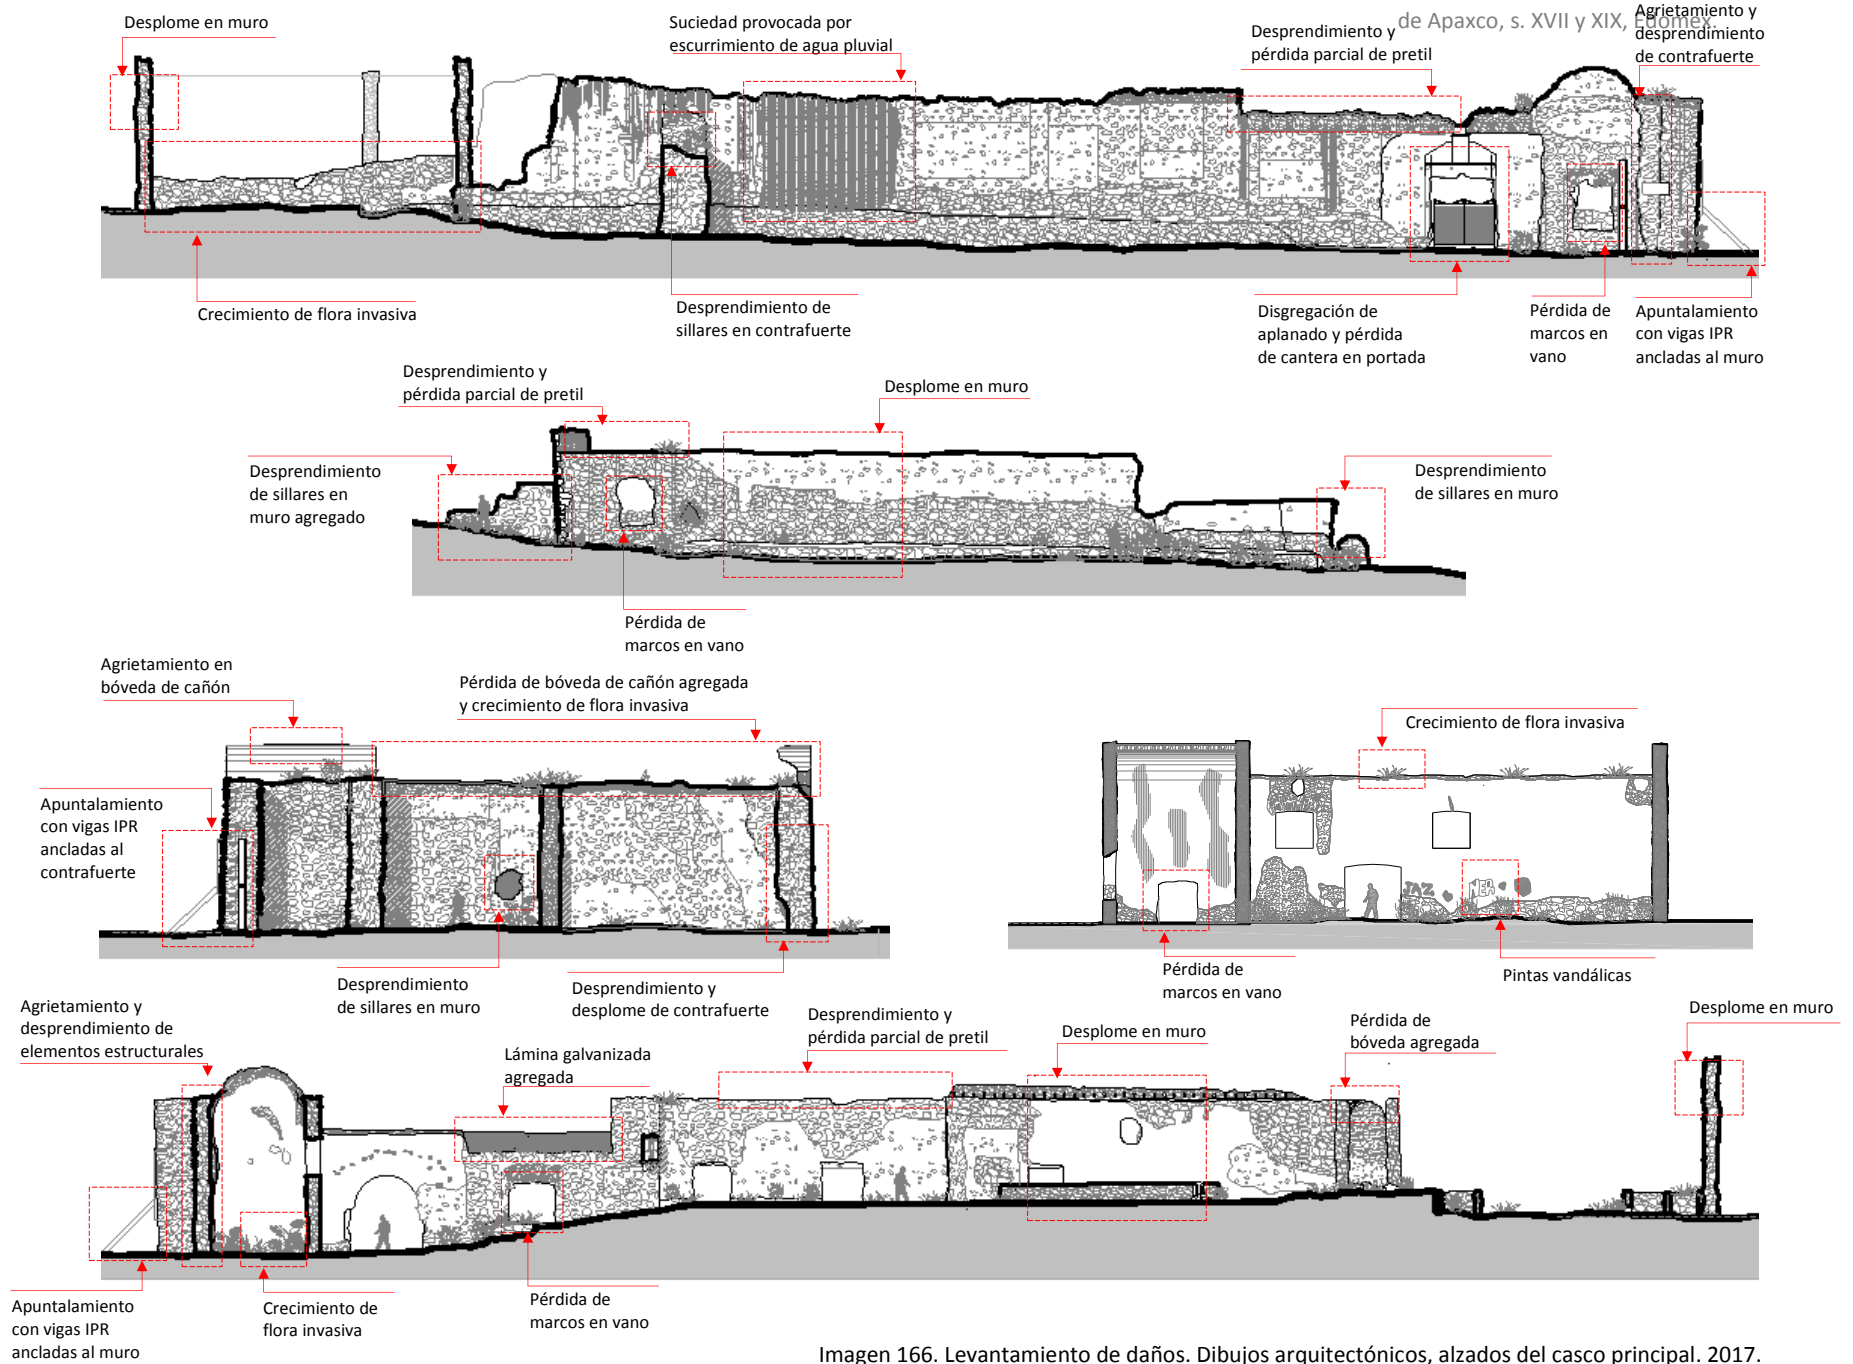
Levantamiento de daños. Dibujos arquitectónicos, alzados del casco principal. 2017.
